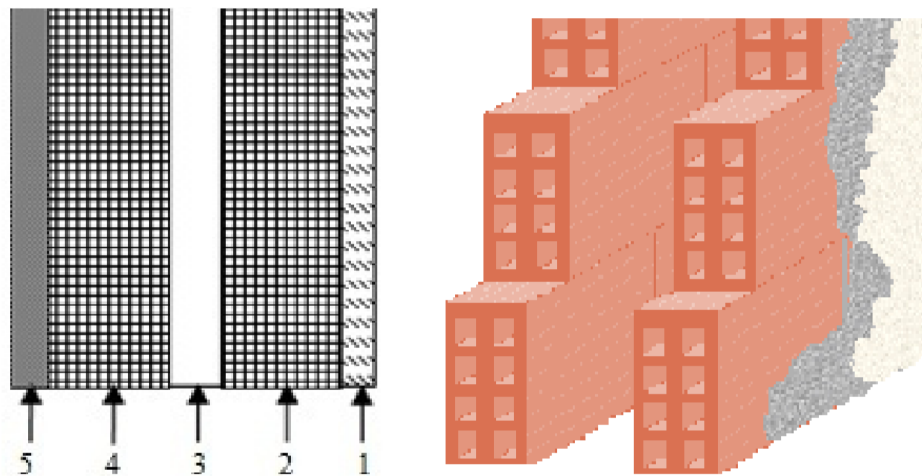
coupe transversale d'un mur extérieur.
